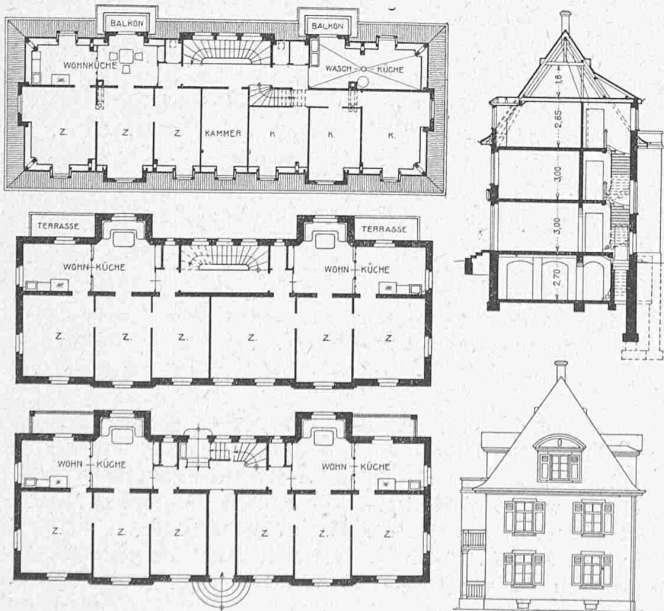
Wohnhaus-Grundrisse, Schnitt und Seitenansicht. — 1:400.
